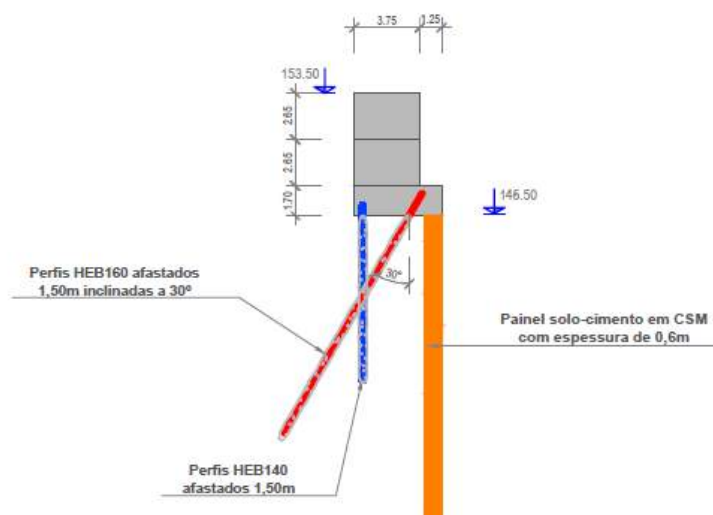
Secção transversal do muro de coroamento de betão simples da solução alternativa em *CSM*.
